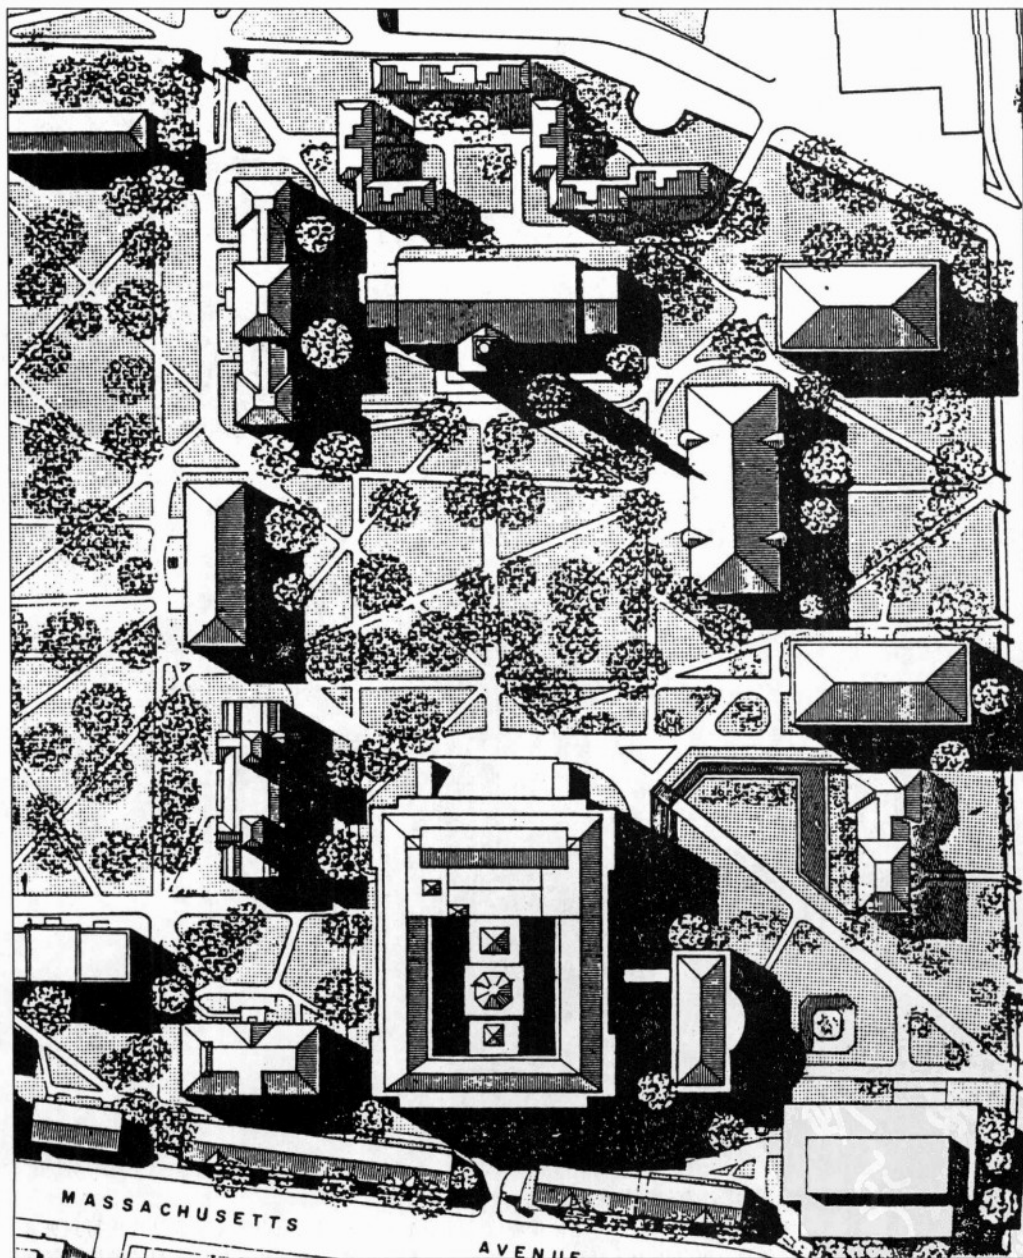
马萨诸塞州哈佛大学的庭院平面图
